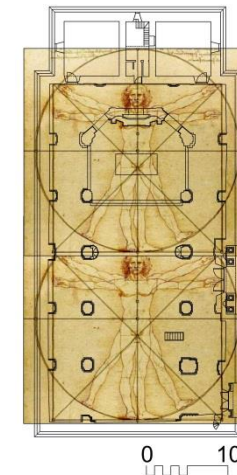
Planta del edificio sobre dibujo del hombre de Vitrubio.
